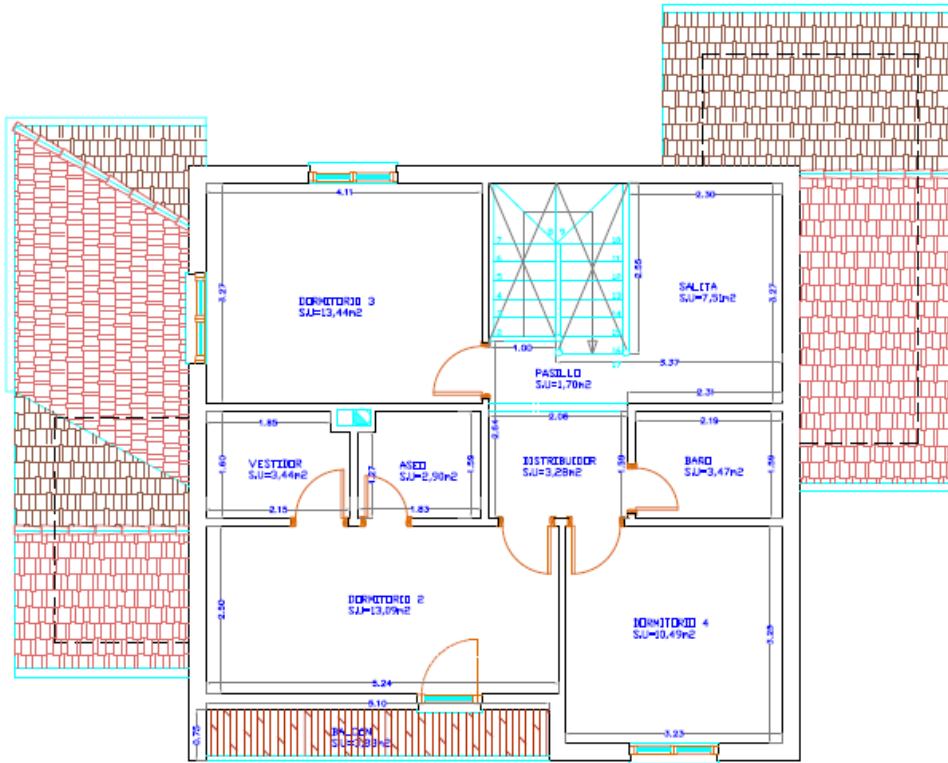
Plano primera planta de la vivienda (Fuente: Elaboración propia)
